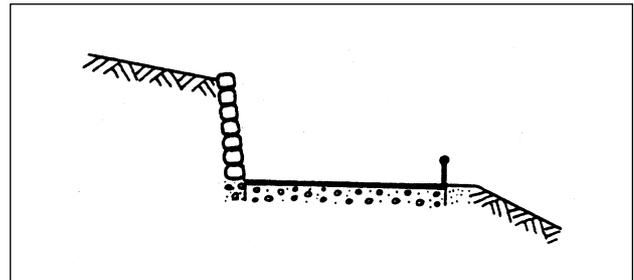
Muro di spalla tipico di muratura in pietra naturale:
